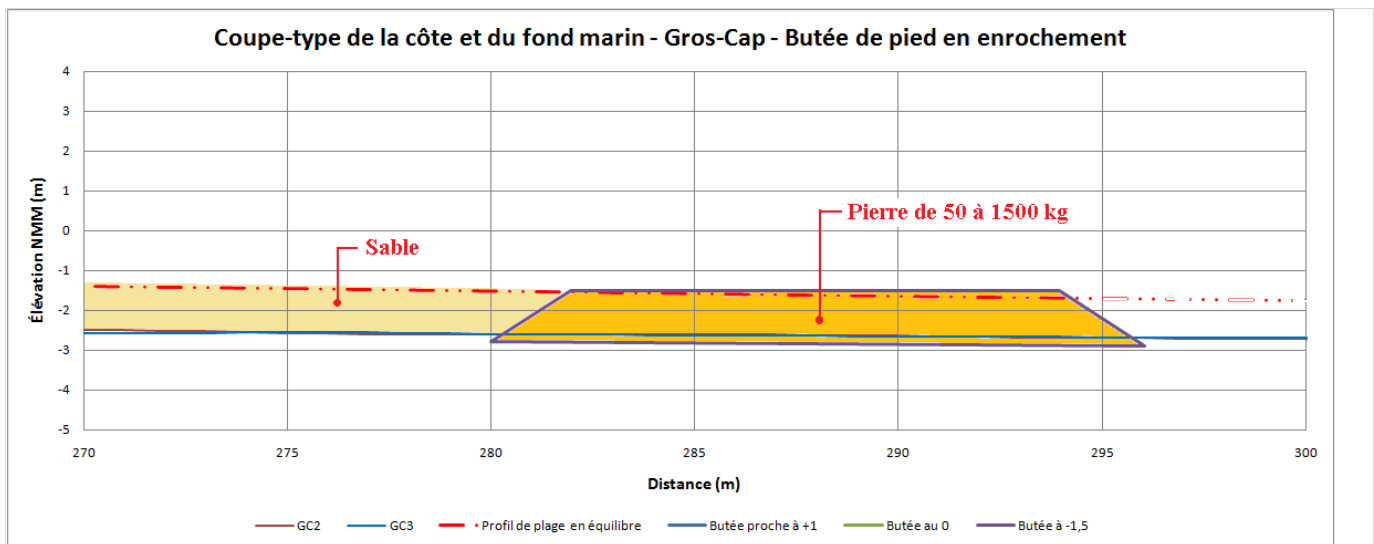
Coupe type d'une butée de pied de plage suspendue en enrochement à -1,5 m NMM
